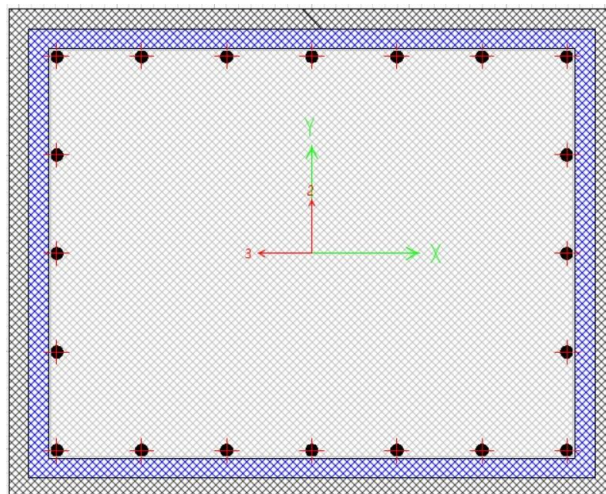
Columna con encamisado de acero. Fuente: SAP 2000.
